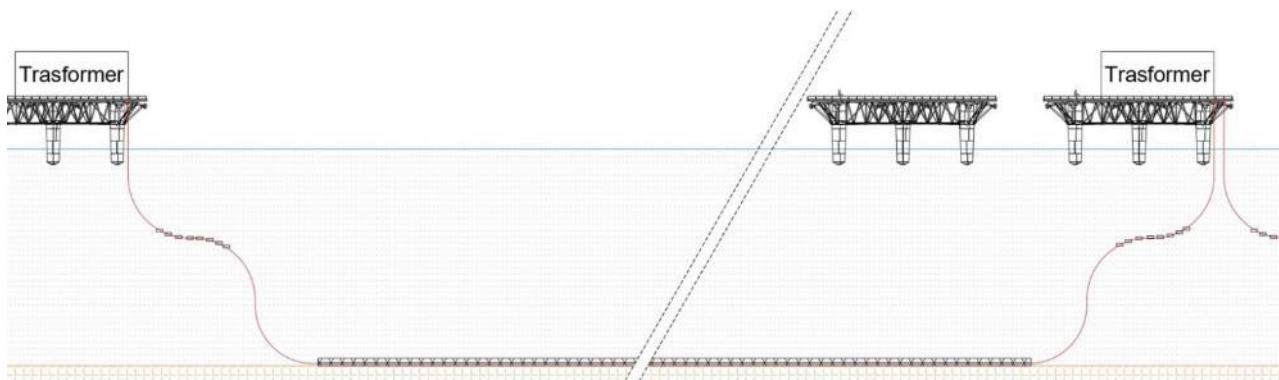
Collegamento Lazy S con posa su fondale con protezione mediante massi naturali
